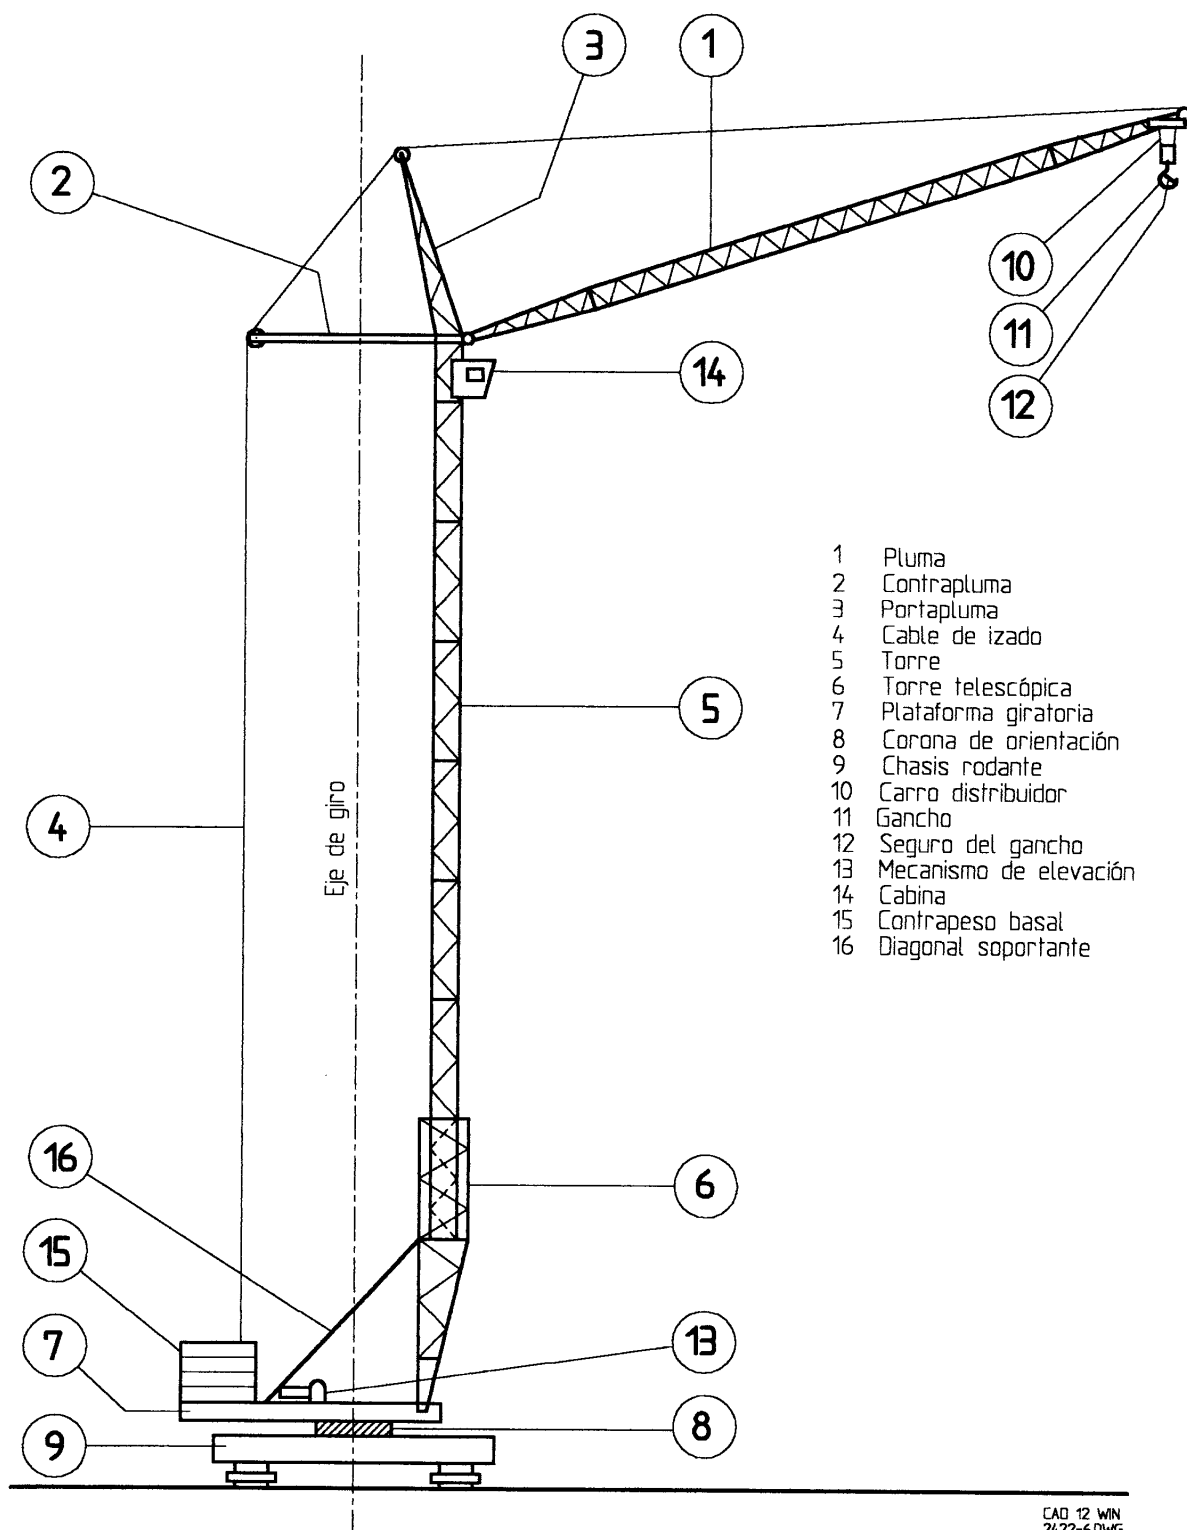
Grúa torre automontable, de giro basal y pluma basculante
